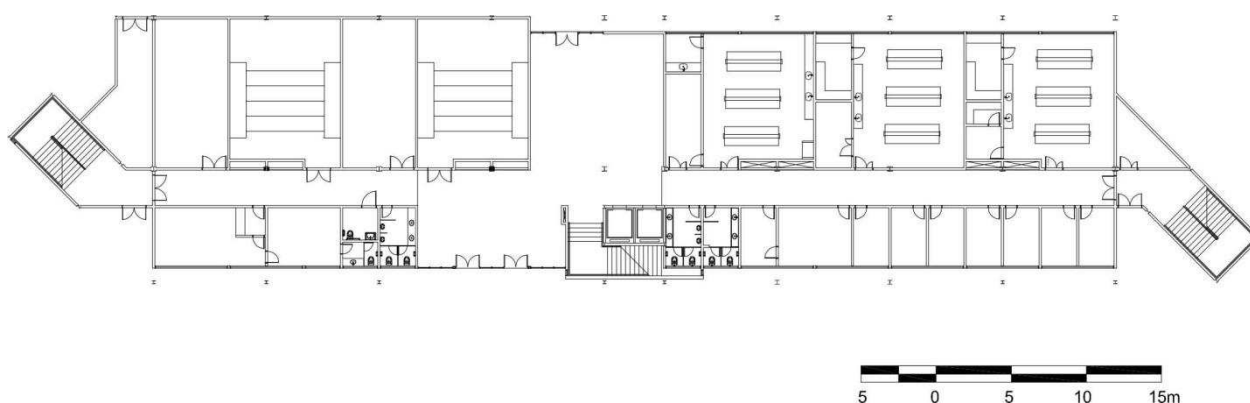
Planta do pavimento térreo do Edifício do Centro de Ciências Biológicas II.
